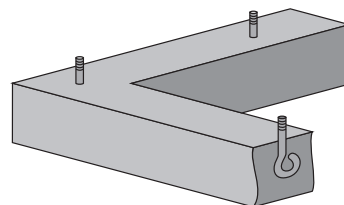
Фрагмент ленточного фундамента с анкерными выводами
